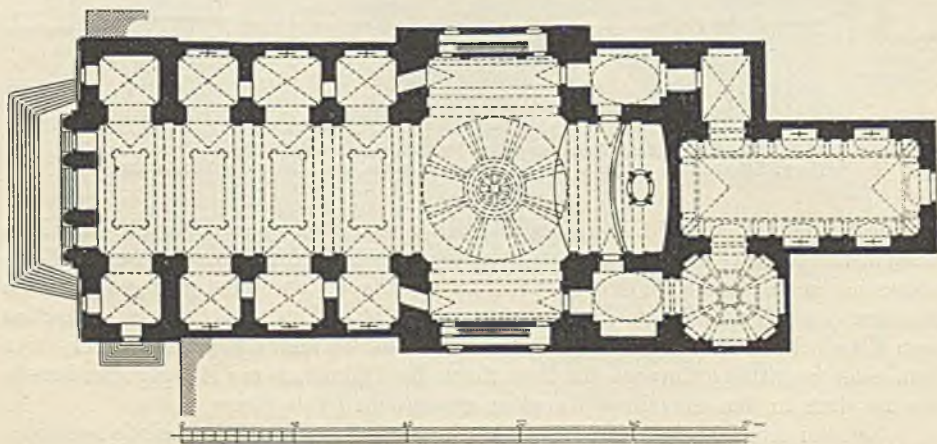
Grundriß von San Juan Bautista zu Toledo
